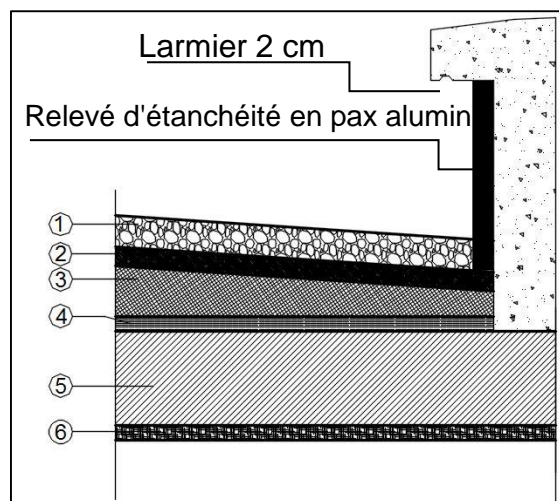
coupe sur (porte à faux) Dalles pleines terrasse inaccessible.
